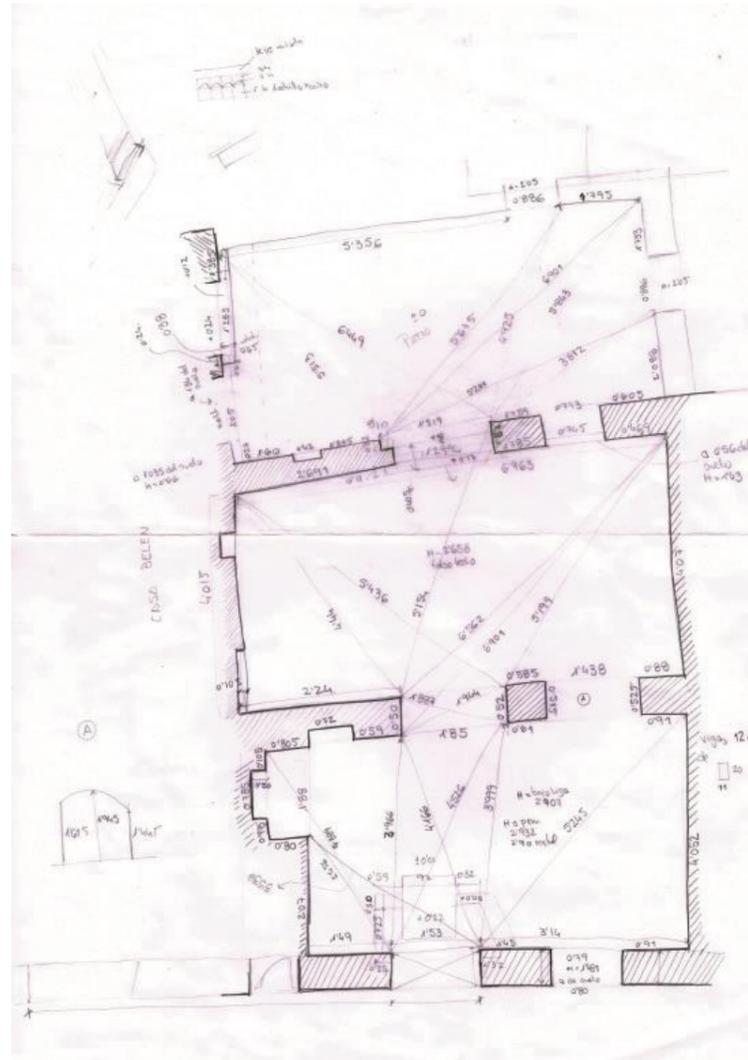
Croquis P. baja viv. c/Puzol 8
